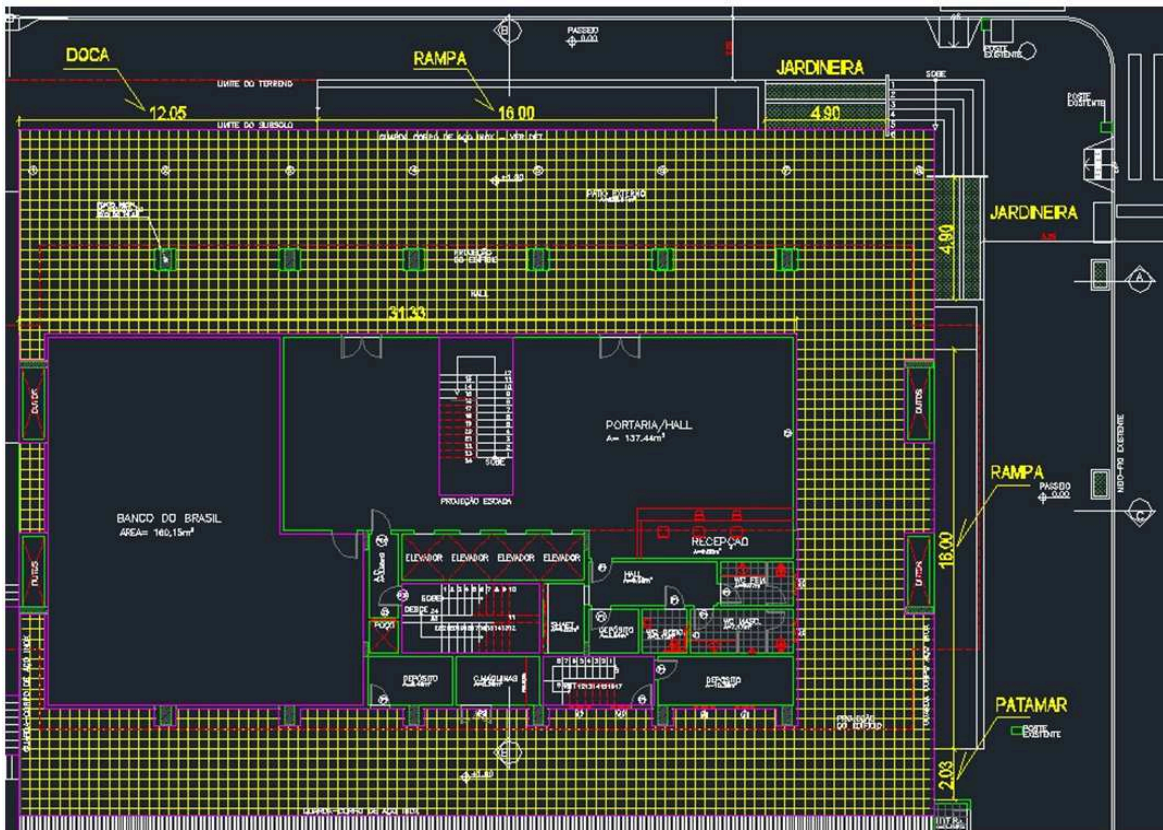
Planta do pavimento térreo do Ed. D. Helder. Destaques das medidas das paredes a receberem granitos novos.
